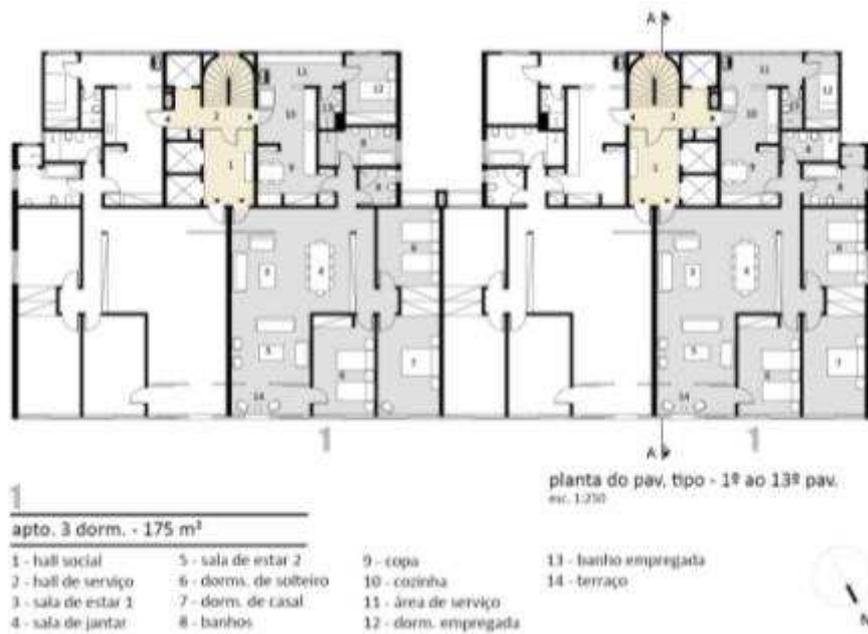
Planta do pav. tipo do Ed. Lausanne (desenho do autor)
